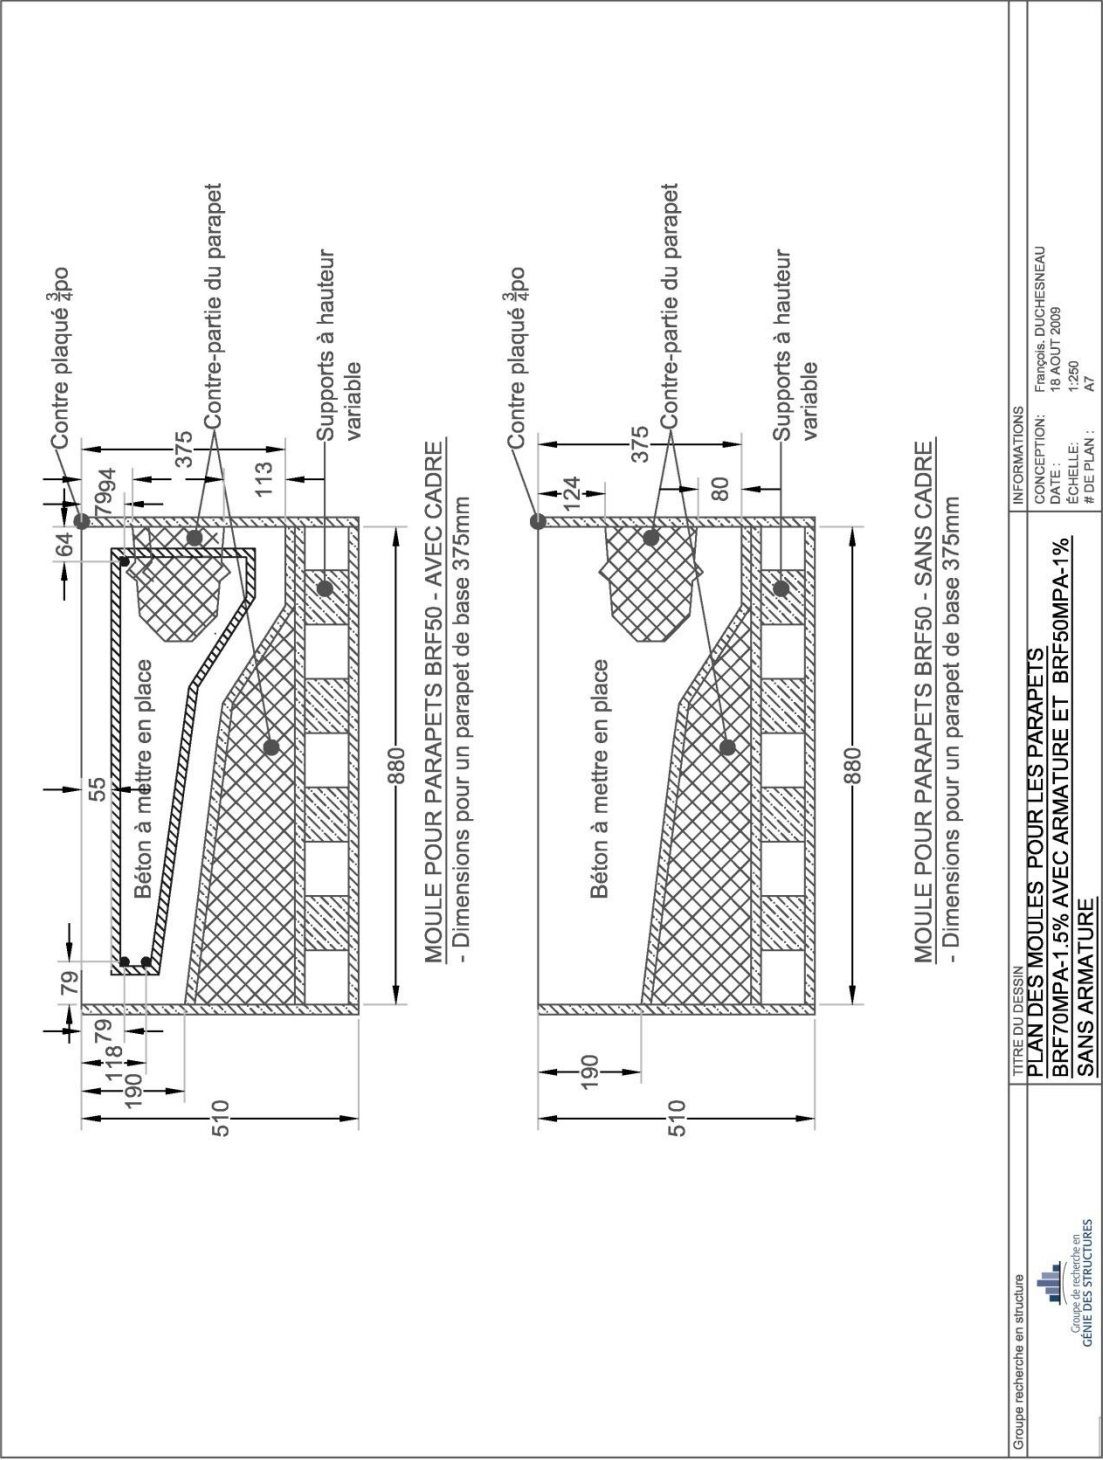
Plan des moules pour le parapet BRF70Mpa-1.5% avec armature et le parapet BRF50Mpa-1% sans armature
